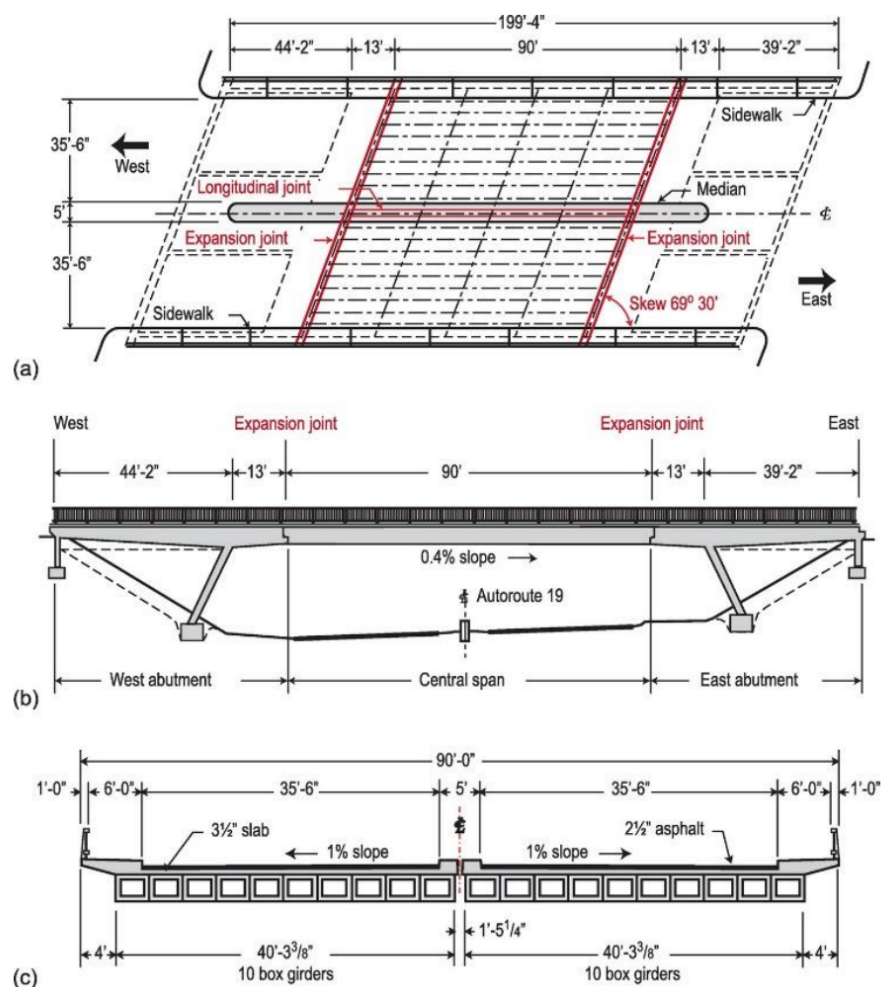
Dimensions du pont de la Concorde : (a) vue en plan (b) coupe (c) coupe transversale perpendiculaire à la coupe (b) [37]
